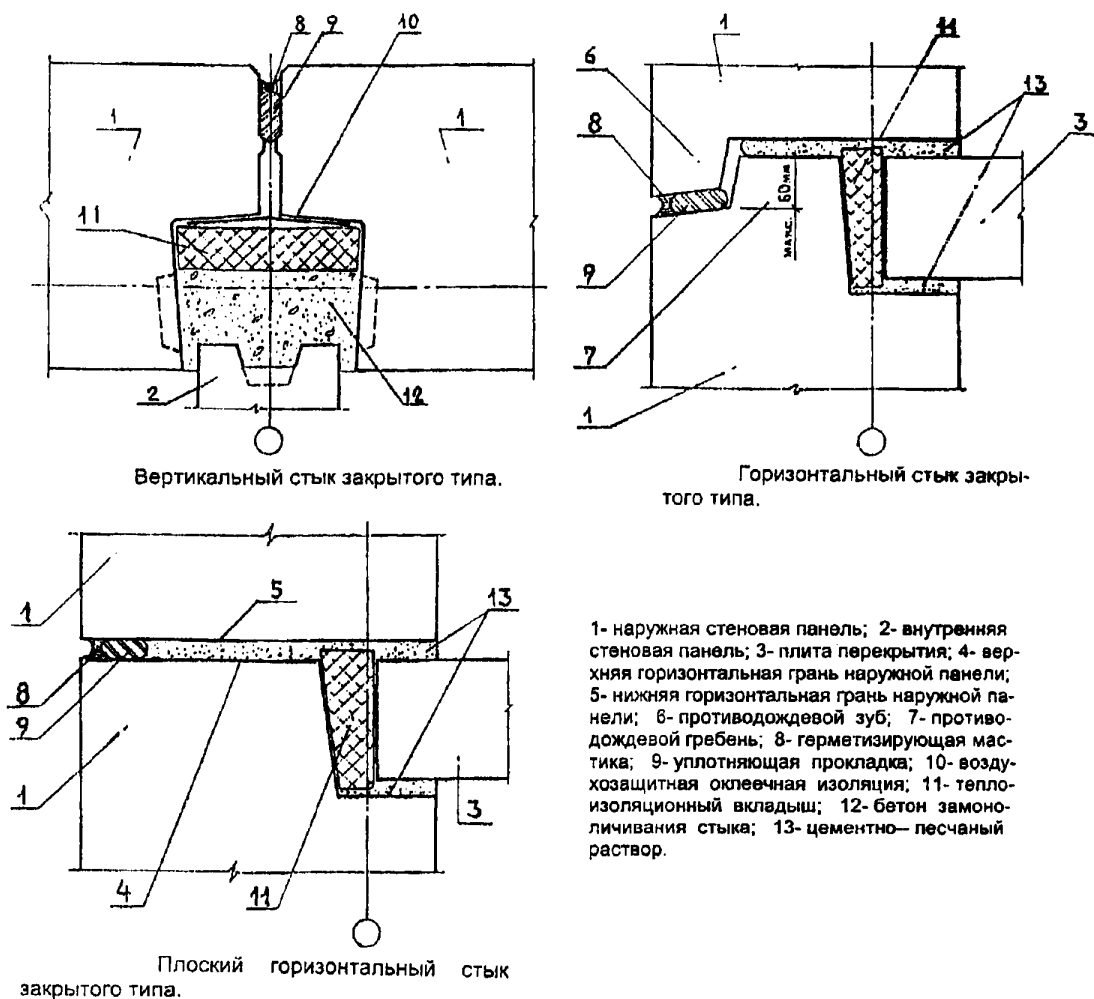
Конструкция стыков элементов наружных стен
